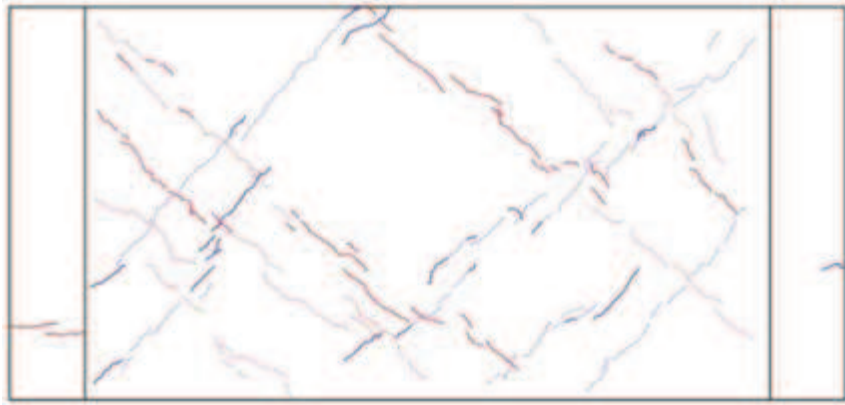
(4) 1/1667rad. におけるひび割れ図
